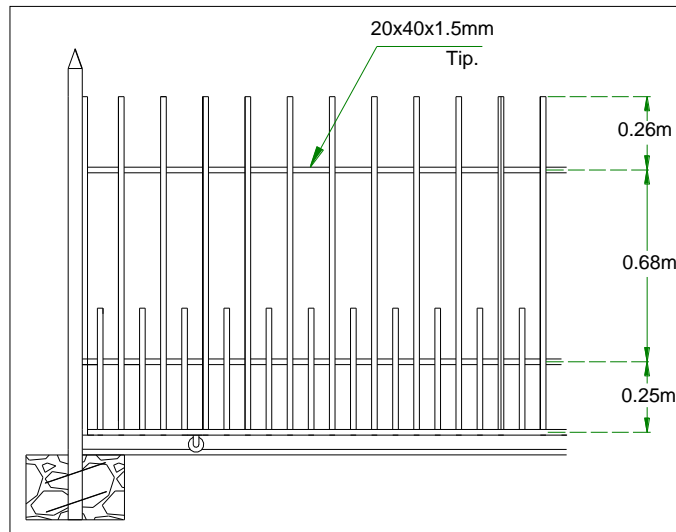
Detalle Portón Automóvil. Fuente Propia
